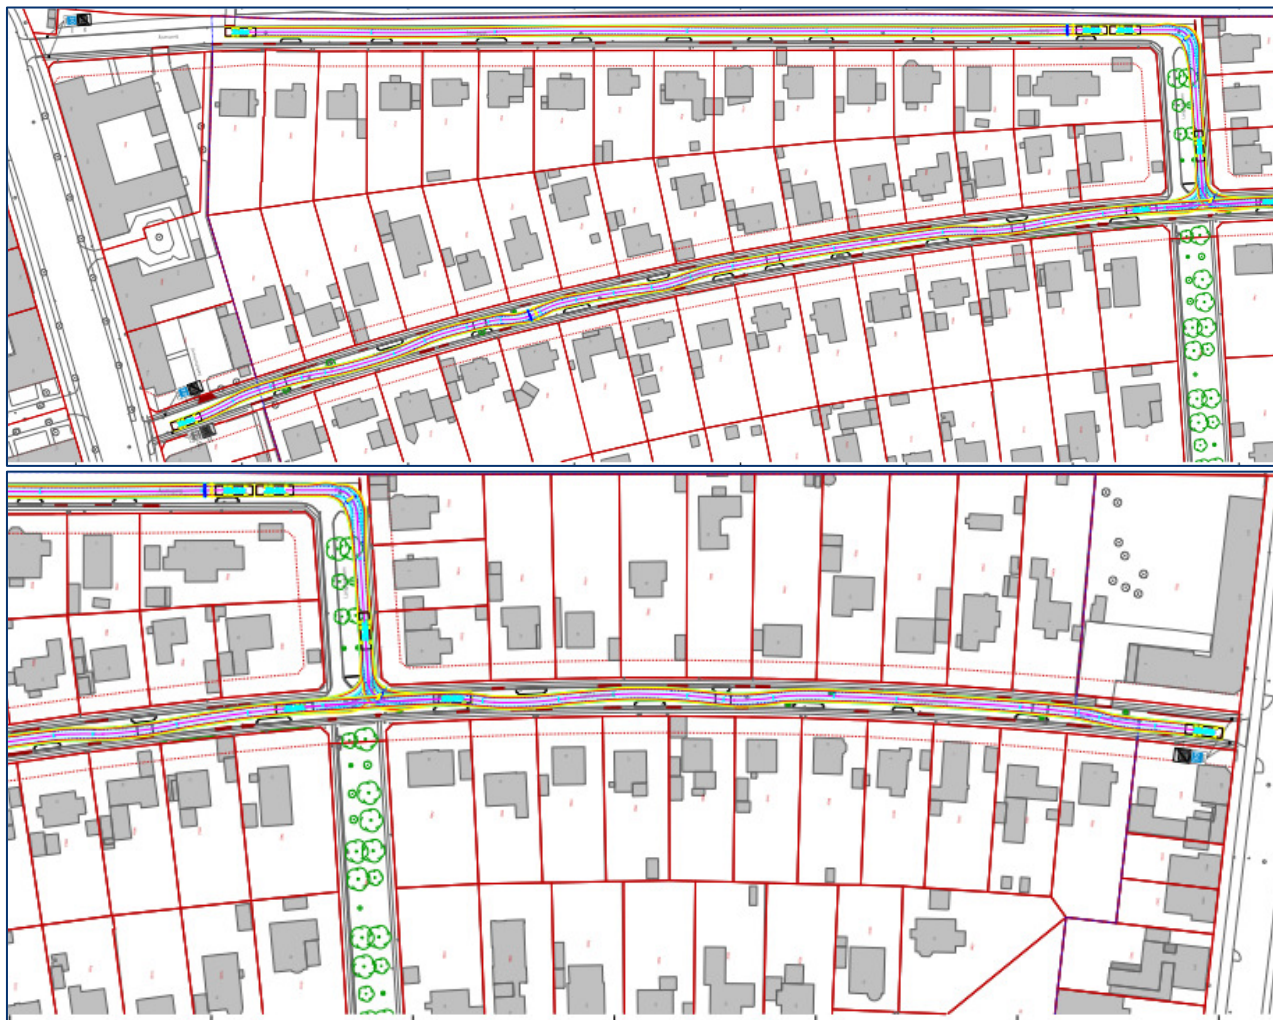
Oversigtsplan over LAR-projektet i GF Søholm.
